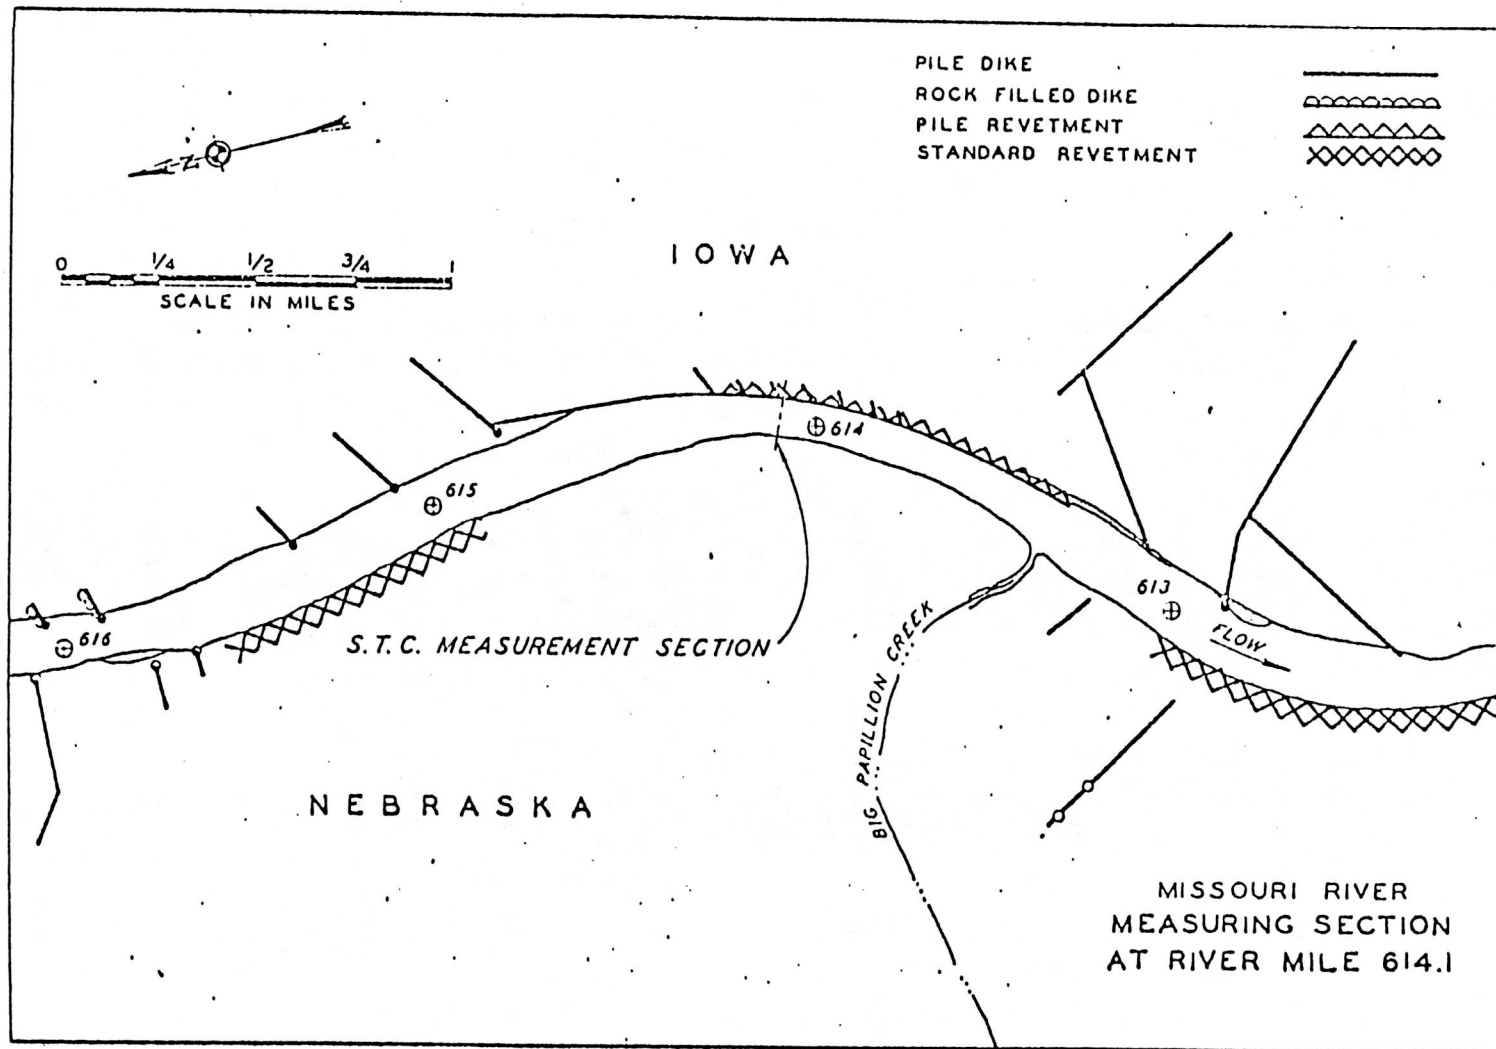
PLANTA DEL RIO MISSOURI
